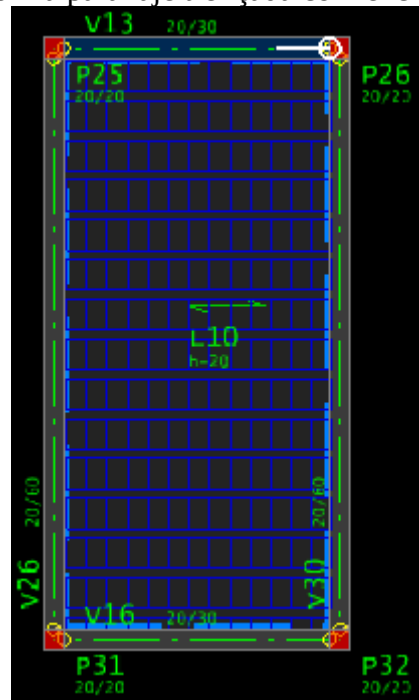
Laje treliçada retangular com enchimento em bloco cerâmico
